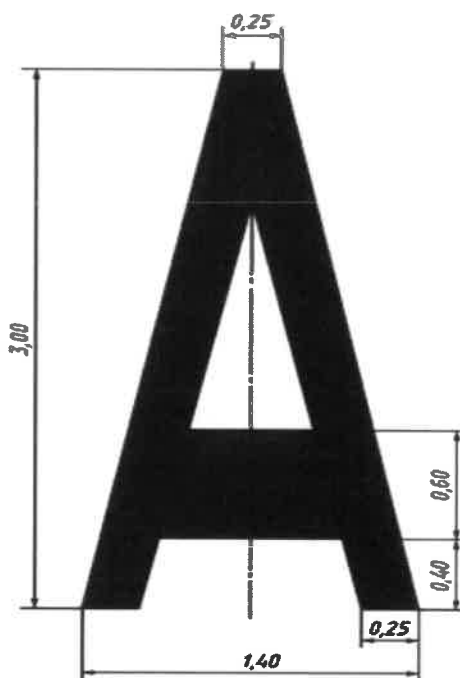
Форма и размеры разметки типа 1.23
